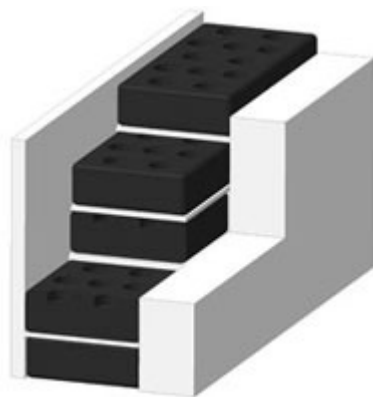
Пример стены с блоками Геокар при строительстве зданий до 10 этажей с наружными слоями из армированного пескобетона
